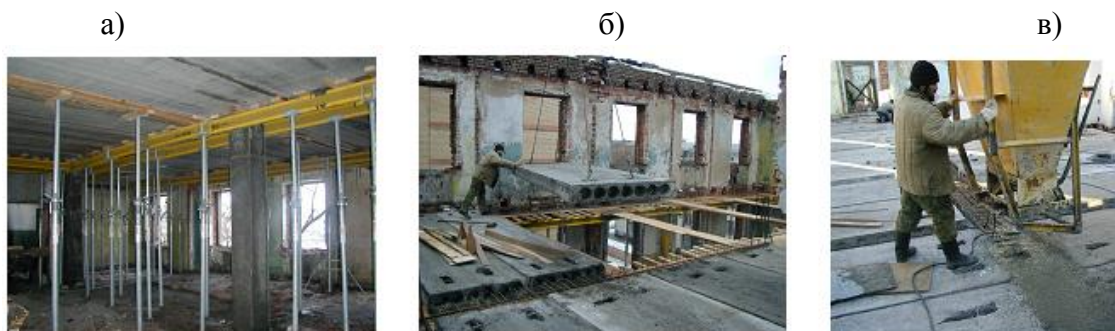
Общий вид монтажно-технологической балочно-стоечной опалубки (а), монтаж сборных многопустотных плит перекрытий (б) и укладка бетонной смеси (в) в опалубку продольных ригелей и оставленные зазоры между плитами
